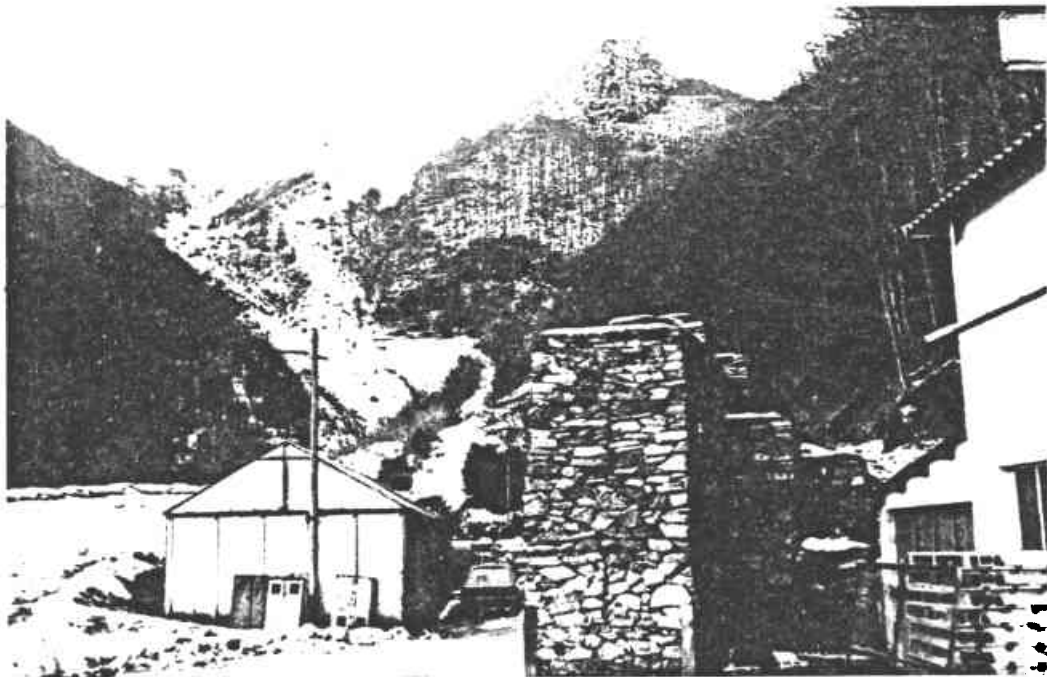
Mur pare-avalanche construit en amont des bâtiments de la mine et au pied du couloir d'avalanche (enneigé)
